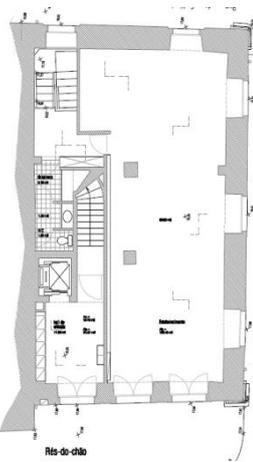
Planta de Arquitectura do rés-do-chão proposta
